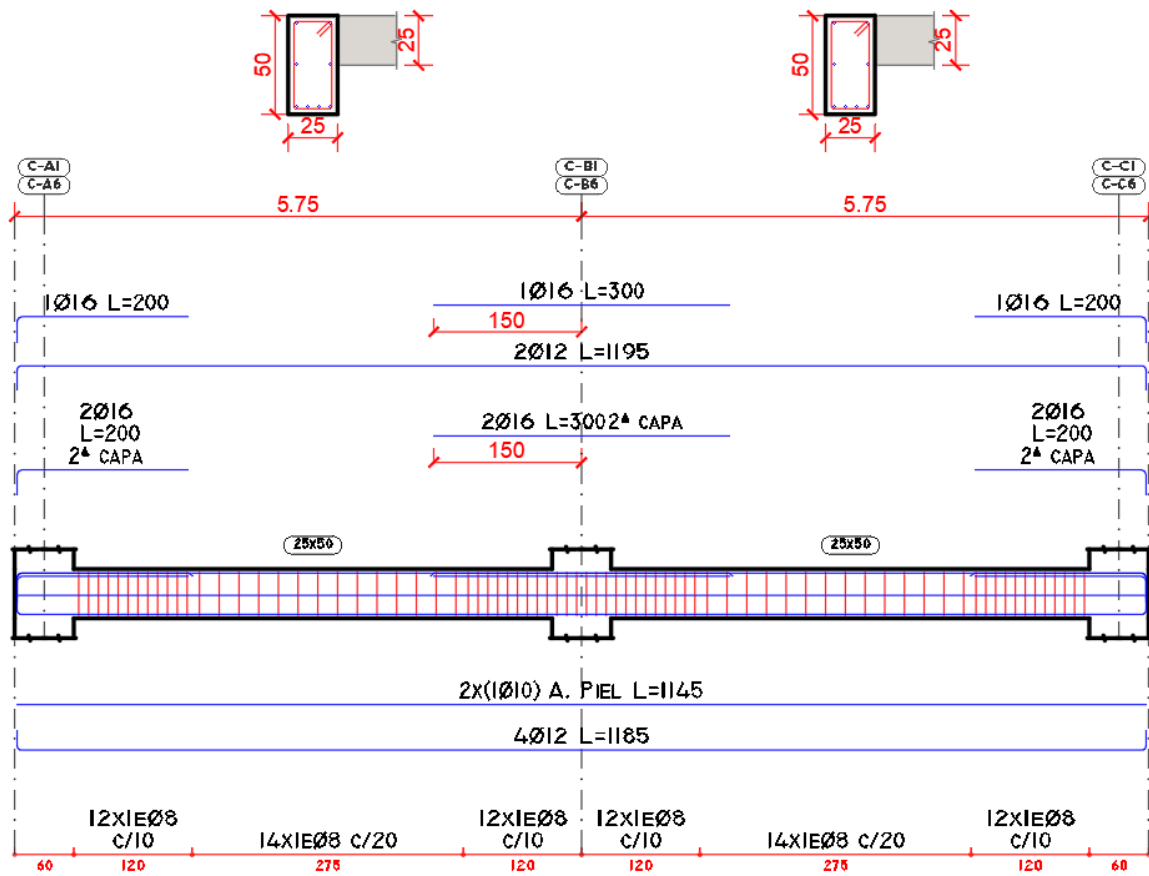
Detalle de Refuerzo Vigas en "X" Losa 5 a 7 Estructura [7N-EE].
